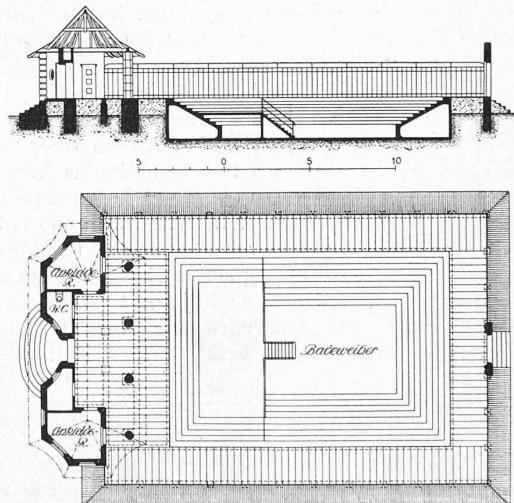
Grundriss und Längsschnitt der Badeanlage zum Schloss Jegenstorf. — Masstab 1:400.
